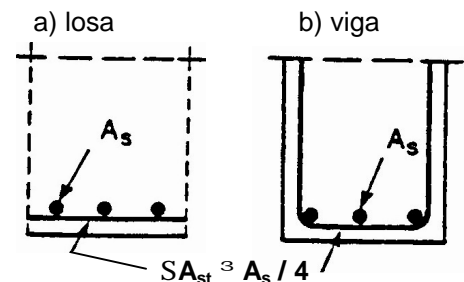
Armadura transversal en la zona de anclaje de armadura
